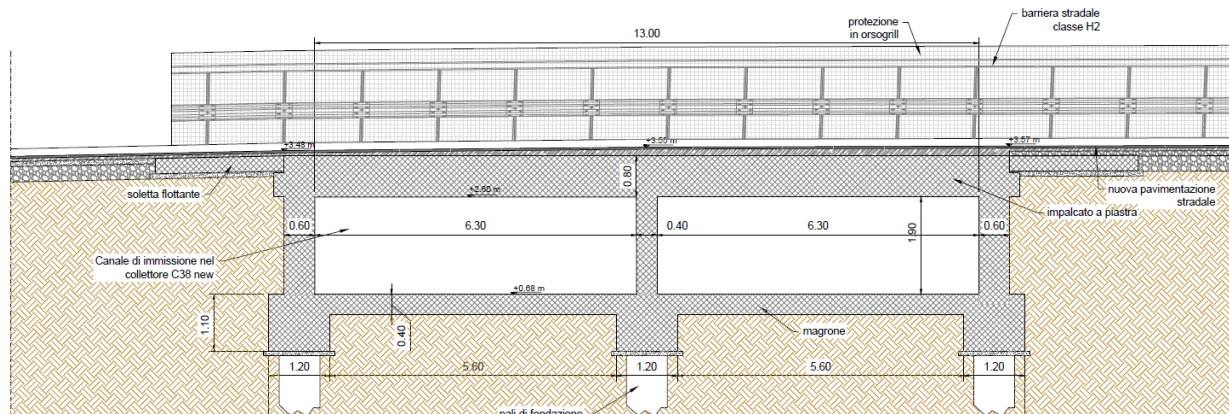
Sezione trasversale dell'attraversamento stradale.
